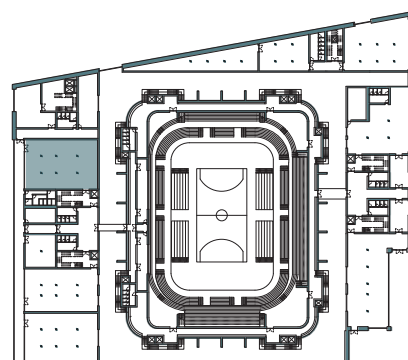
Pianta piano primo e individuazione uffici caso studio
